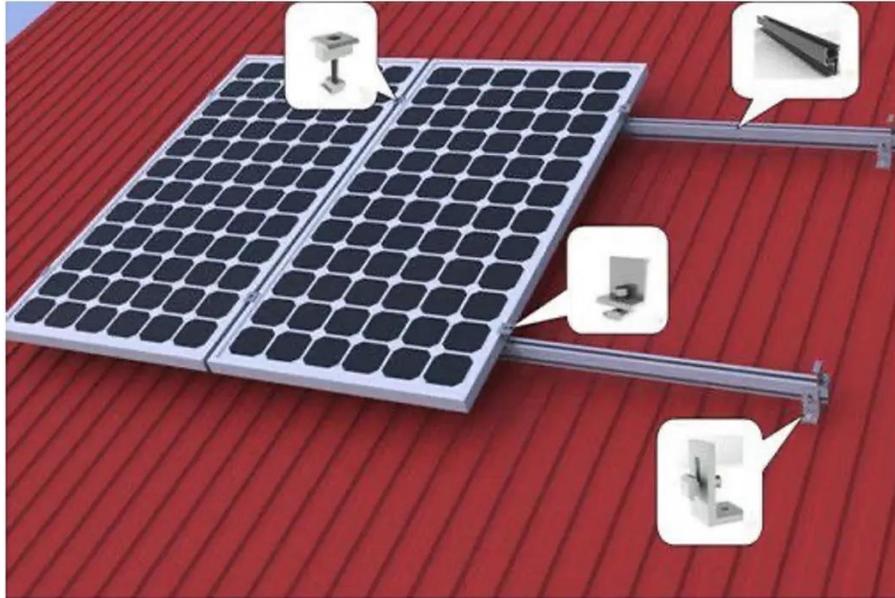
Estructura de montaje para instalación paralela a techo. (DMUenergy, s.f.)
